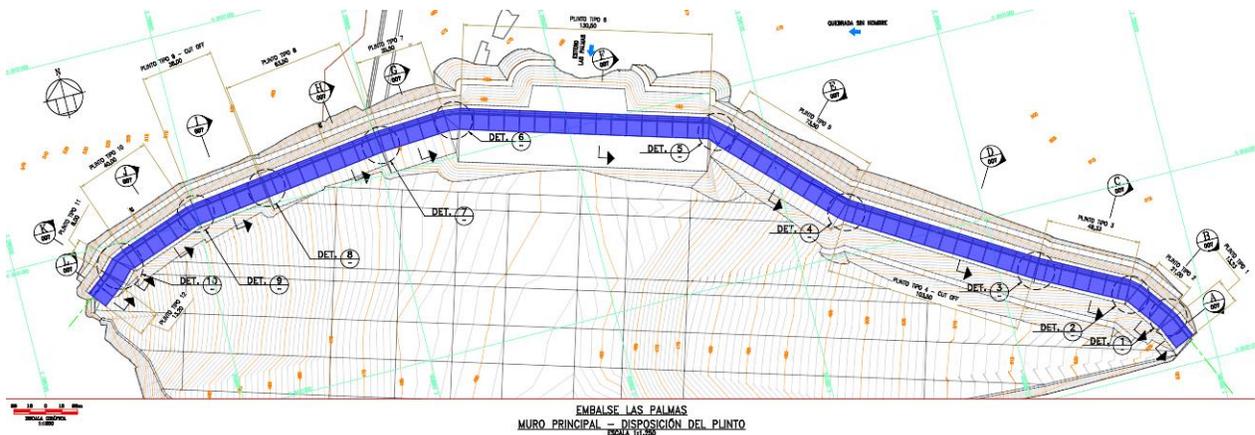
Plano en Planta del Plinto, secciones y detalles.
